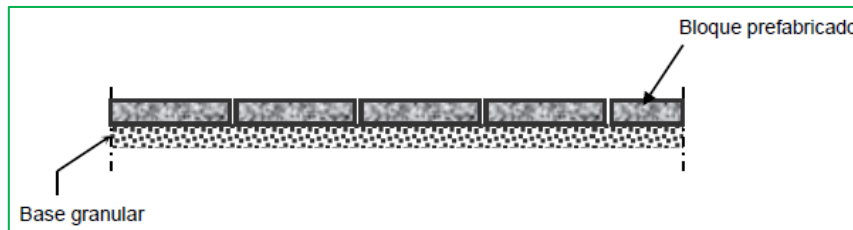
Pavimento Prefabricado. Fuente: Pavimentos de Concreto para carreteras. (Ref. Bibliografía 5)
